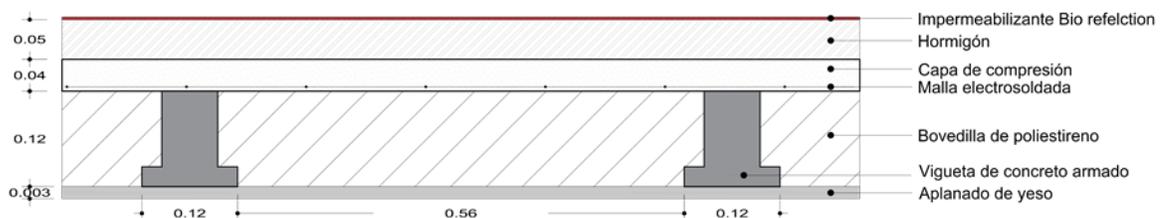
Detalle de losa con propuesta de impermeabilizante (Corte)
